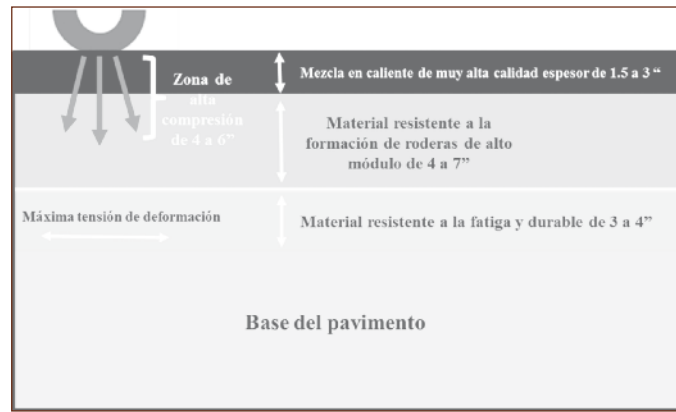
Diseño de un pavimento asfáltico de alto módulo.
